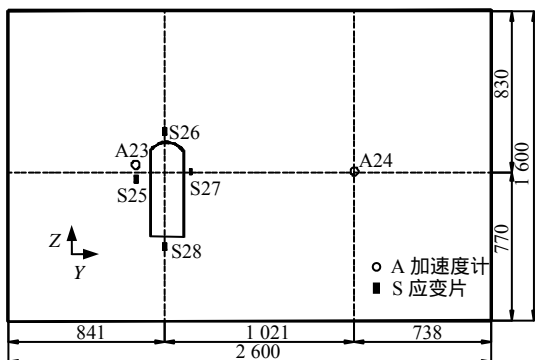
辅助测试断面 2 传感器的布置图 (单位: mm)
